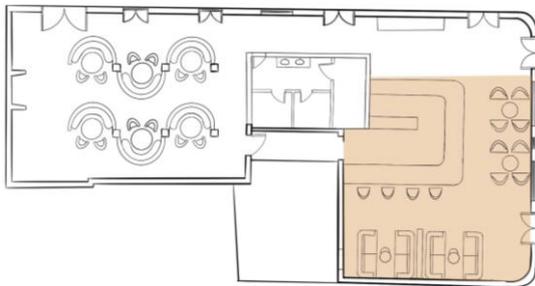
Primeiro Esboço de Zonamento Zona Lounge
